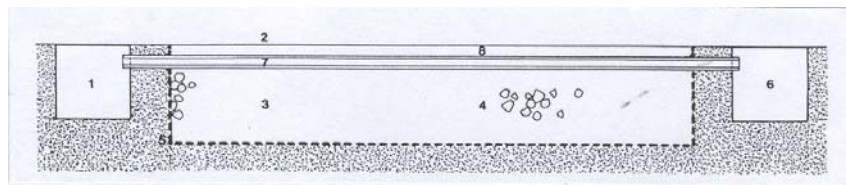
1.- Cámara de entrada (opcional), 2.- Alimentación superficial, 3.- Zanja, 4.- Relleno, 5.- Geotextil, 6.- Cámara de rebase (opcional), 7.- Tubería de distribución (opcional), 8.- Cubierta.
